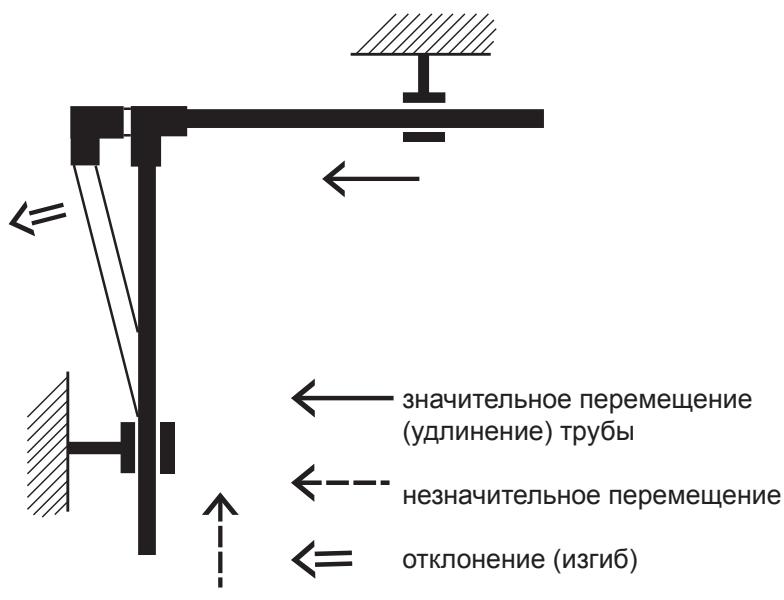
Держатели, допускающие продольное перемещение труб (скользящие опоры)
